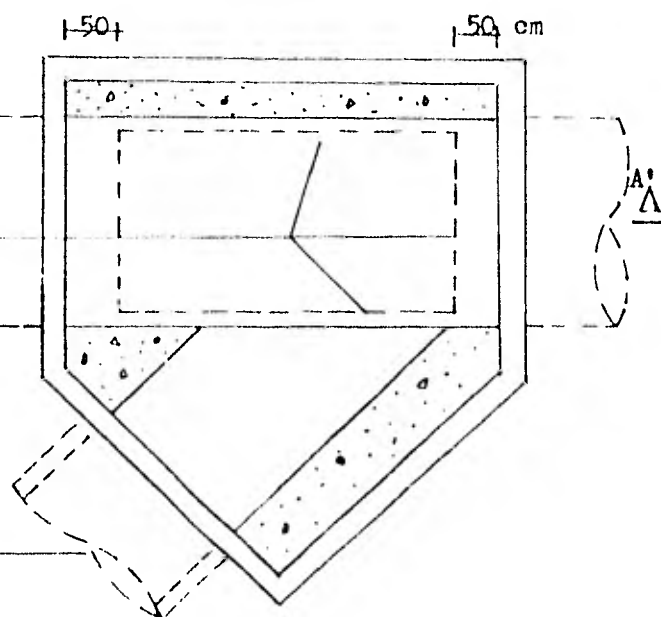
Procedimiento de demolición del tubo, puede apreciarse en primer término la Planta y posteriormente un Corte de la Caja de Conexión.
